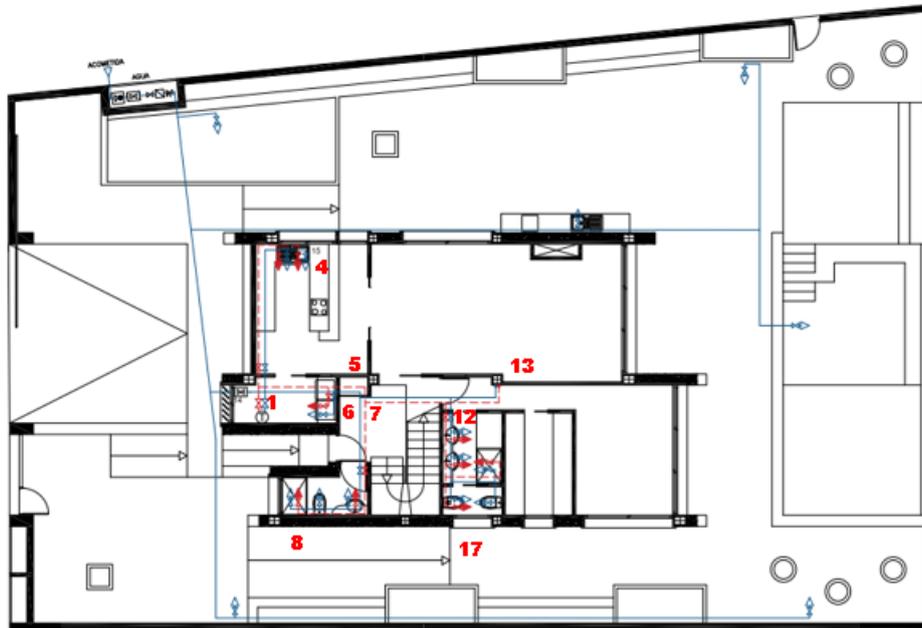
5. Tramos de distribución agua caliente, planta baja
